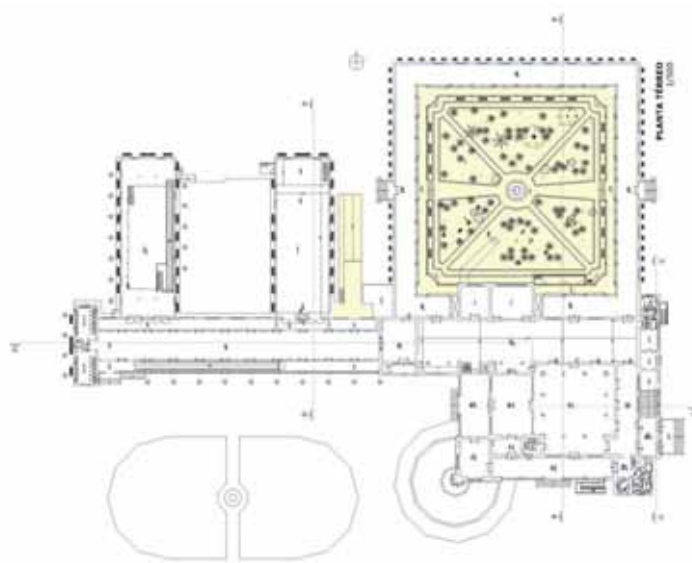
Planta baixa pavimento térreo (Fonte: Catavento Cultural e Educacional).
